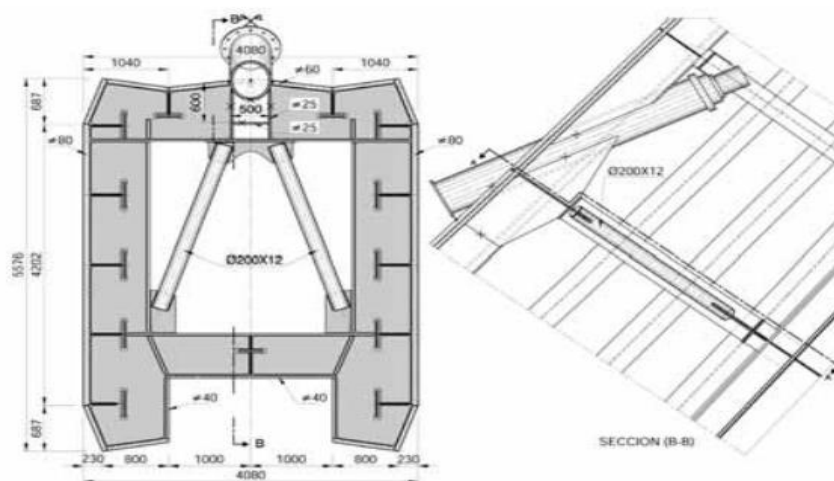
Sección tipo y anclaje de tirante en pilono
